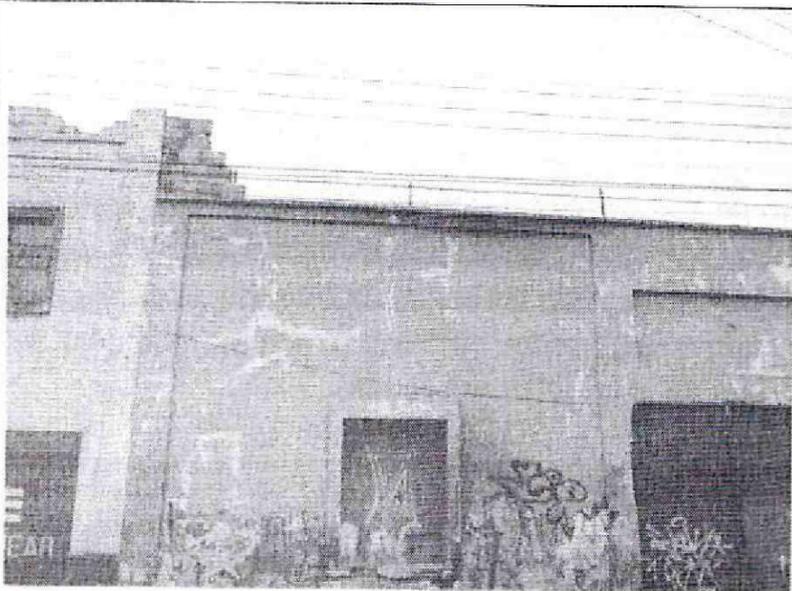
Fisuras y grietas en tramo occidental del muro.
